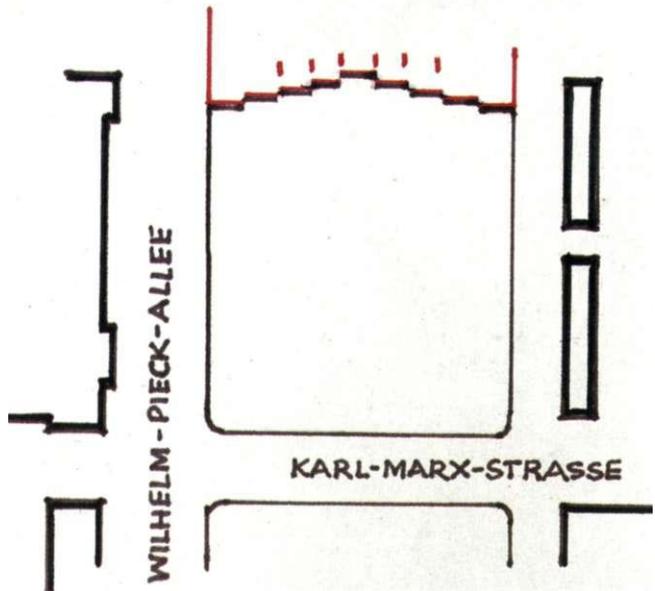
Plan zur Entwicklung des Stadtzentrums, 1969 publiziert
